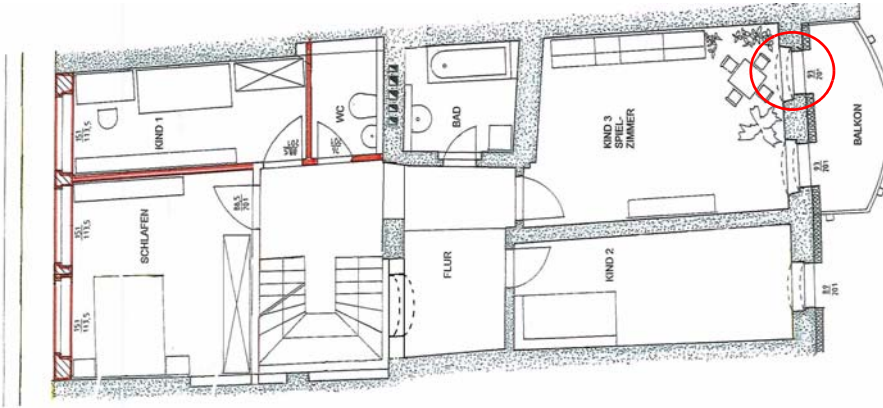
Lage der Messstrecke Außenwand 1.DG Süd im Gebäude
